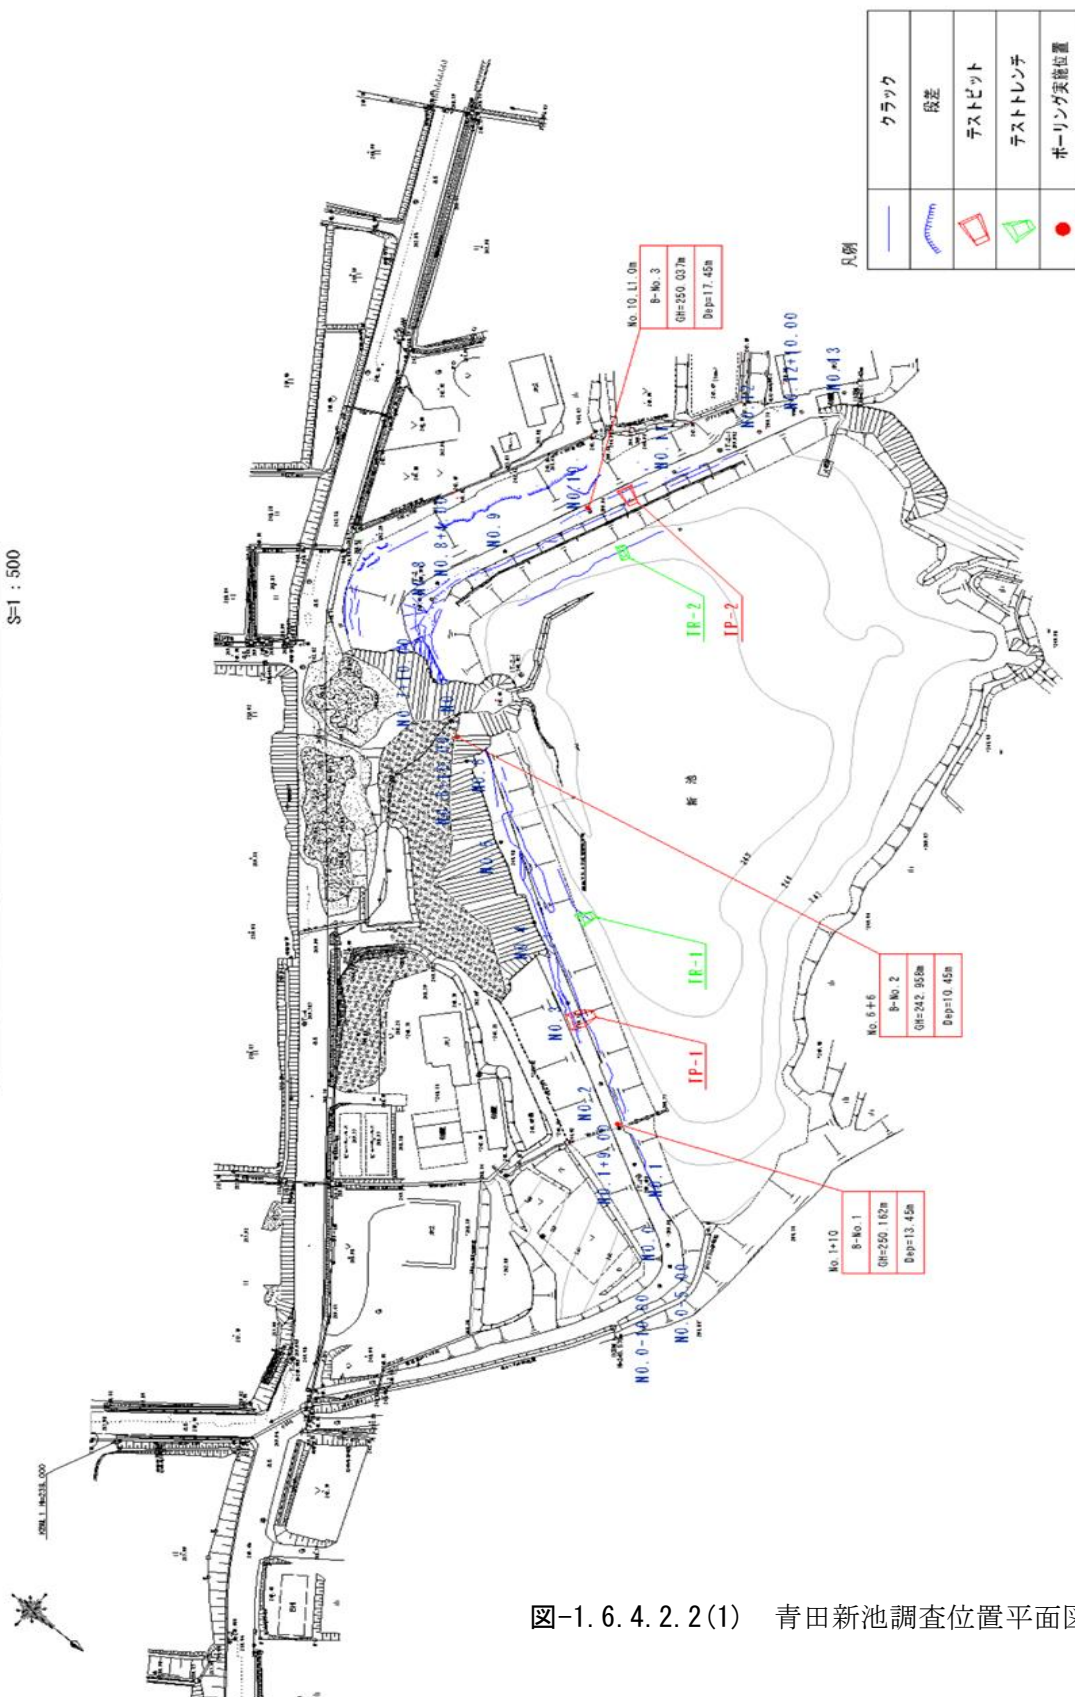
(1) 青田新池調査位置平面図(二次調査)
